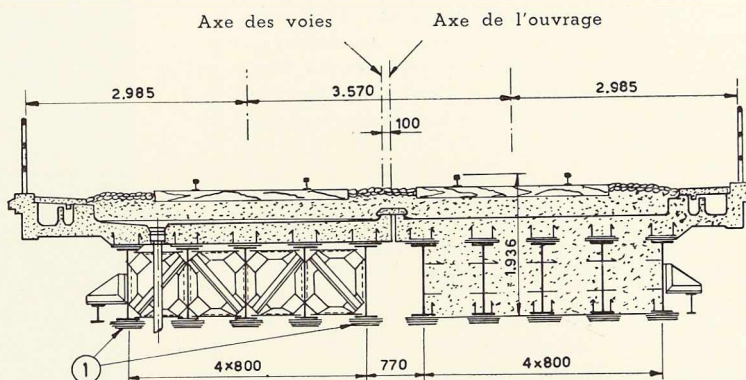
Pont de Thionville-Nord. Coupe transversale, Au droit de la travée de rive
